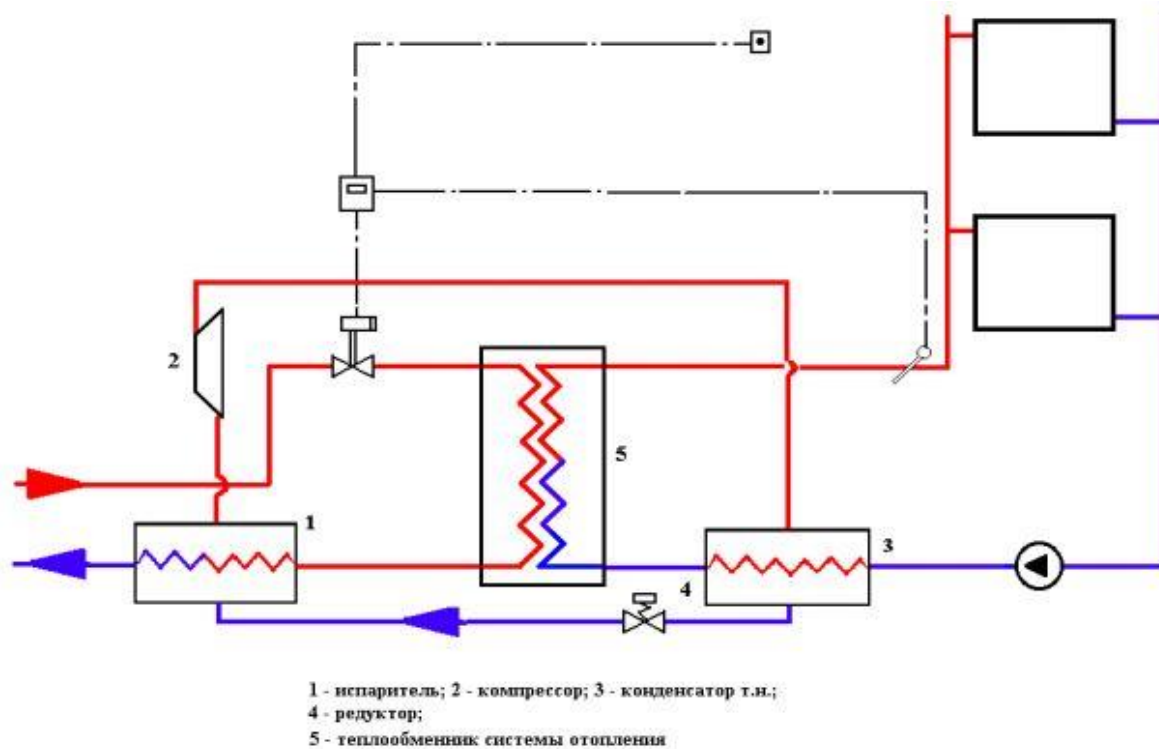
Схема теплового пункта с тепловым насосом с конденсатором на обратном трубопроводе системы отопления
